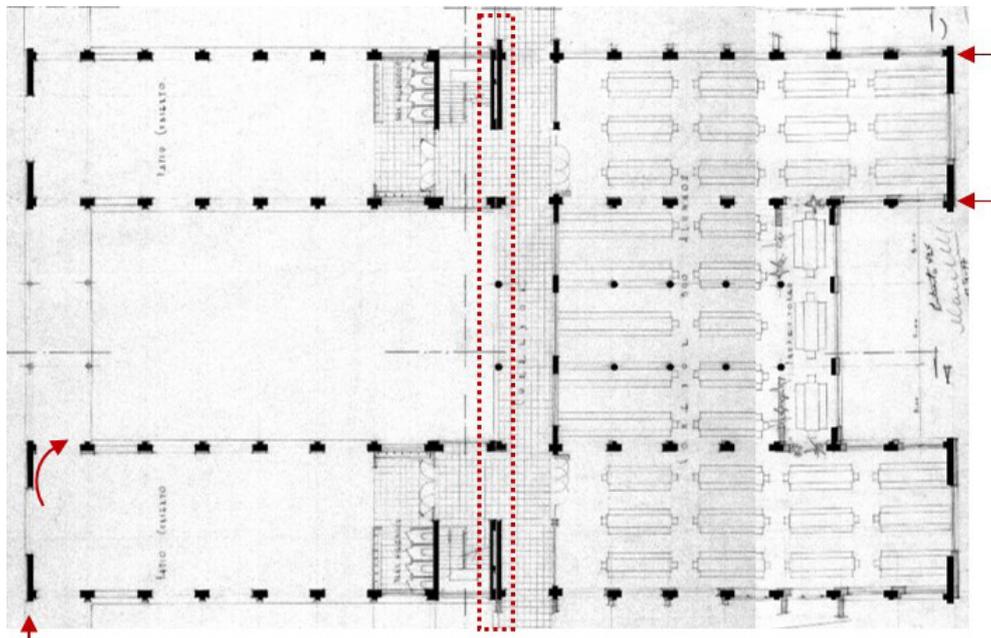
Esquema elevación de estructura. Fuente: Elaboración propia.
